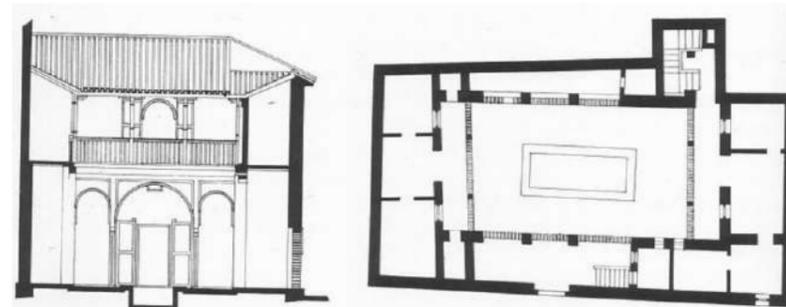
Fachada y Planta de casa de dos pisos en Granada, calle de oro finales del siglo XV. Tomado de (Camesasca,1971).
